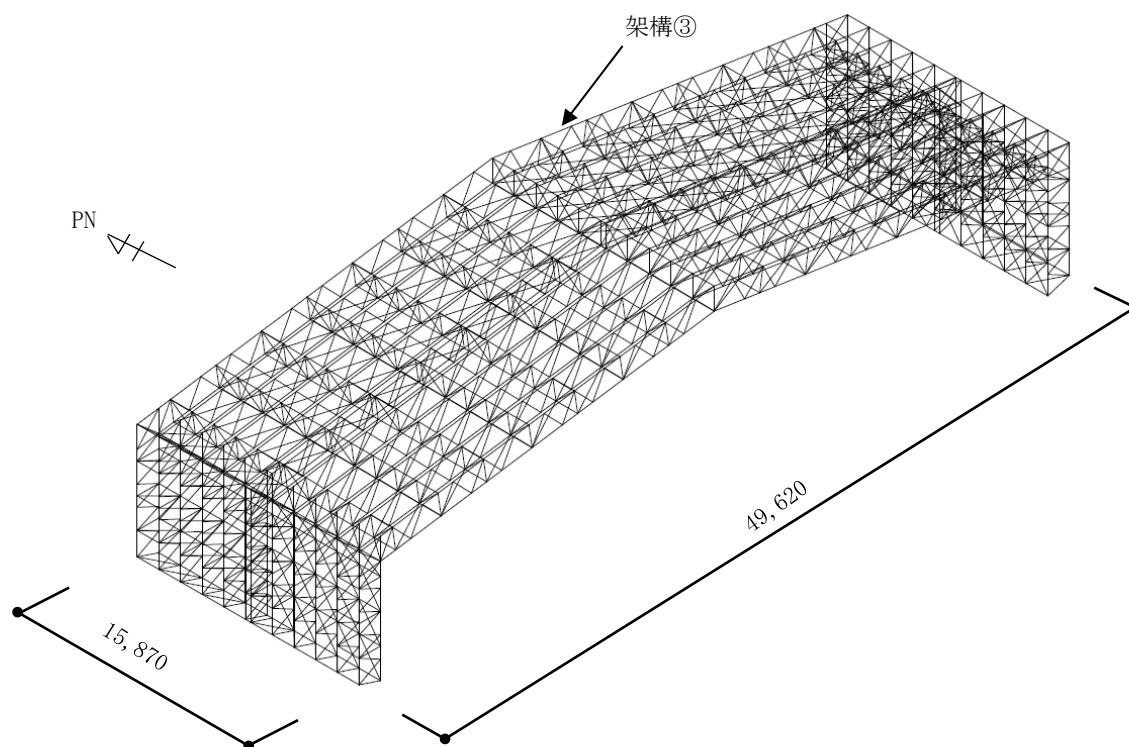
屋根の解析モデル (単位 : mm)
